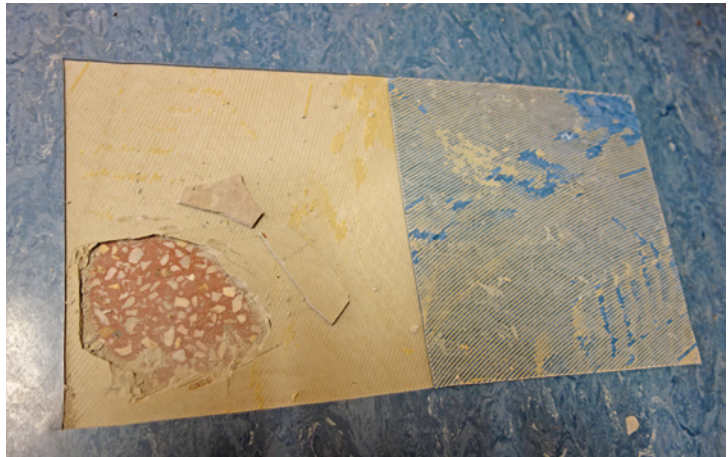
Beispiele für abgeplatzte Spachtelmassen aufgrund nicht fachgerechter Untergrundvorbereitung
